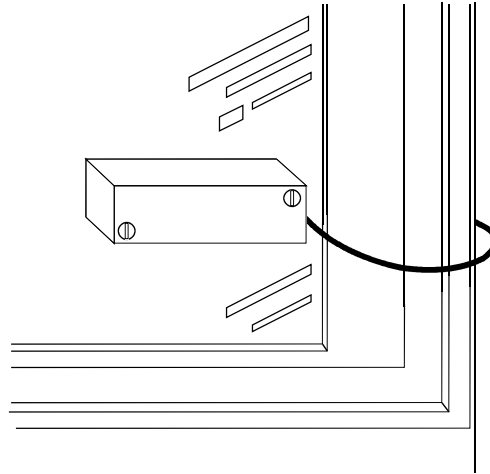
Montaggio di un rivelatore meccanico a vibrazione
